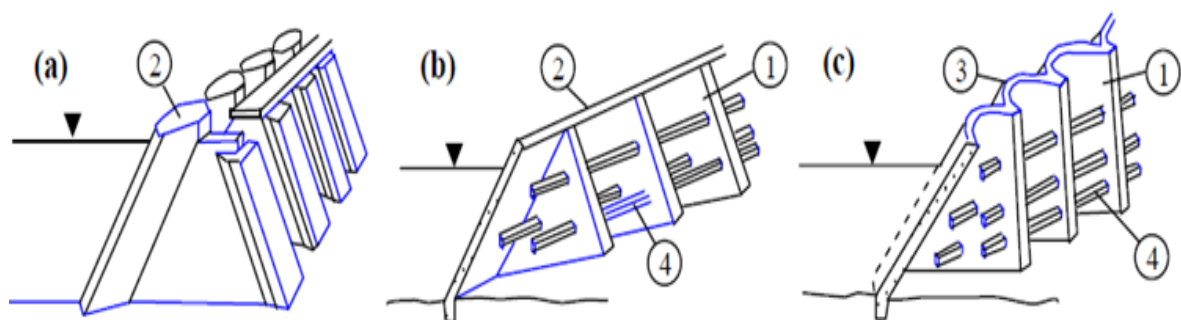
Barrages à contreforts, a) à dalle courbée, b) à dalle plane, c) à multi-voûtes.
